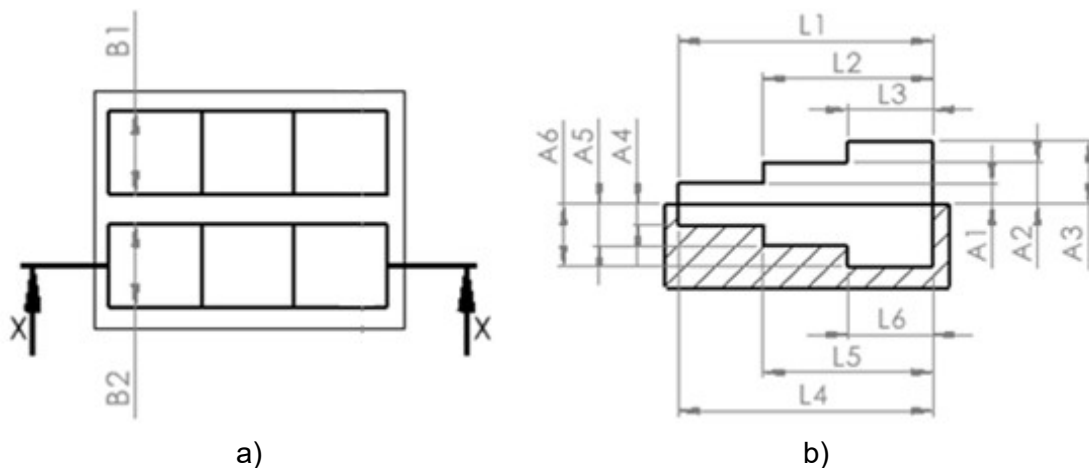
Representación de la leyenda para el elemento Escaleras (a) Planta (b) perfil.
